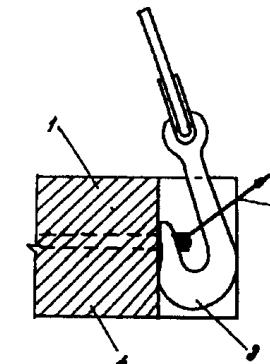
Схема воздействия крюка строп на монтажную петлю при малом расстоянии между монтажной петлей плиты и бетонной поверхностью ниши:
